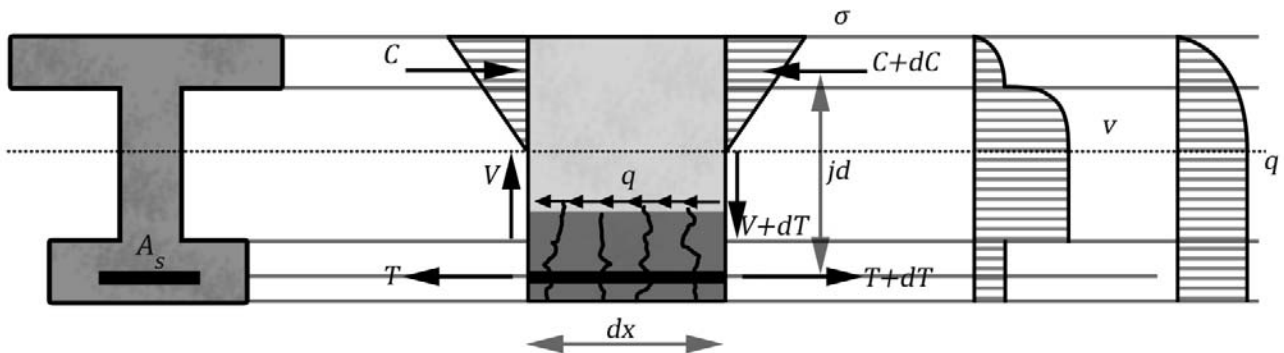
Sección fisurada bajo esfuerzos cortantes
